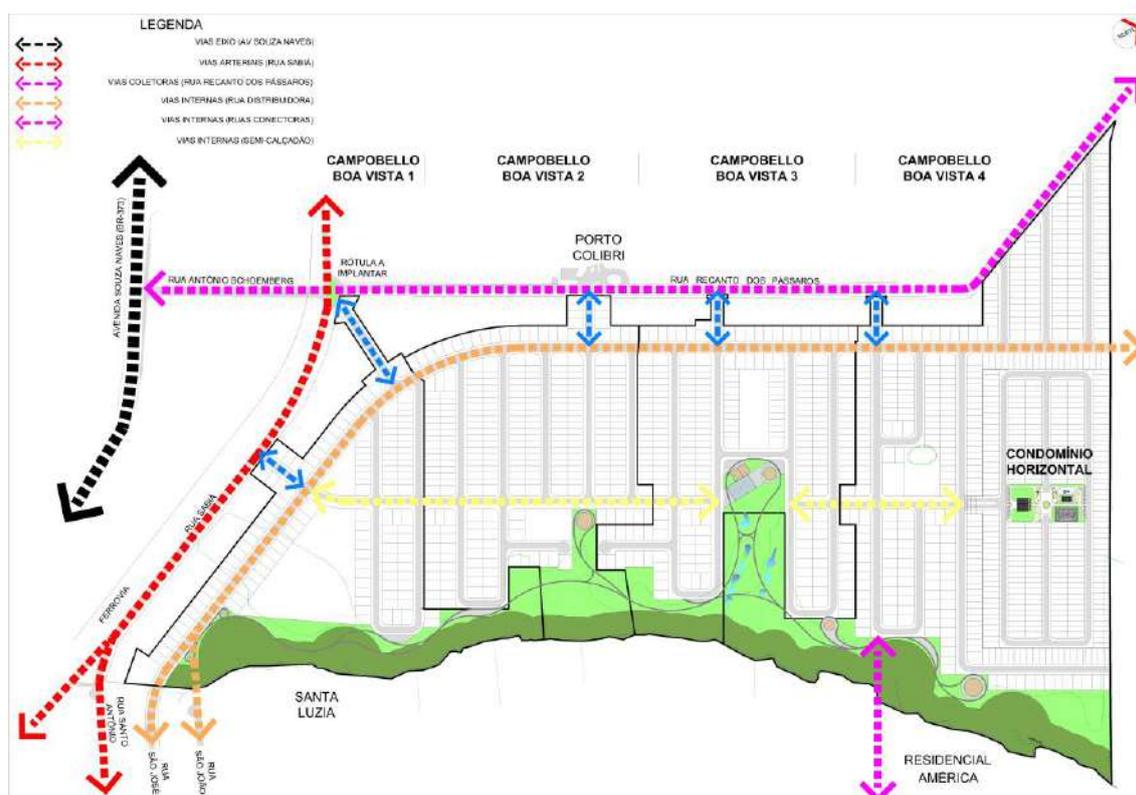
Hierarquização do Sistema Viário do Bairro Planejado
